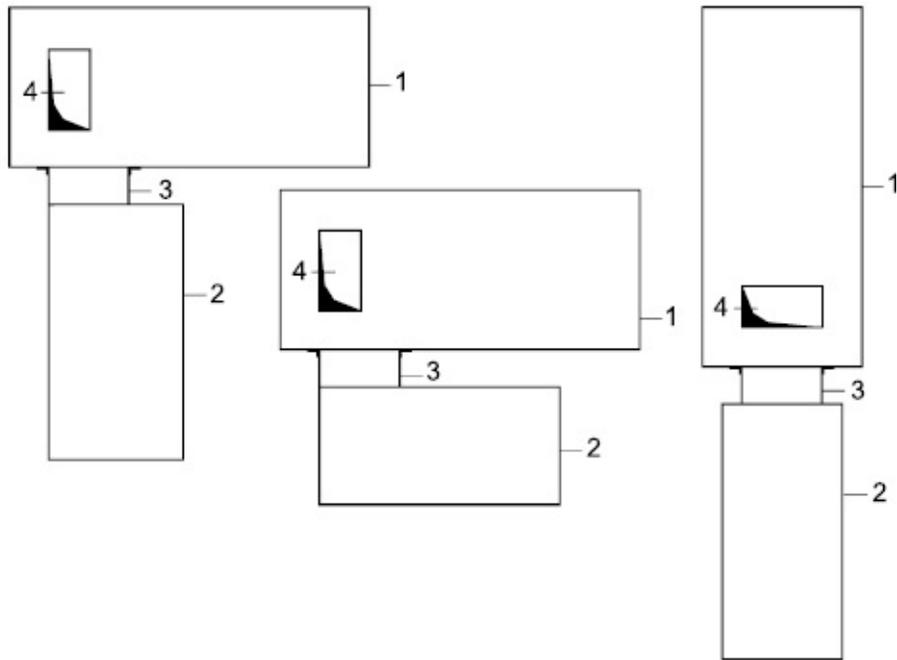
Способы подключения стального топливника к отопительному щитку: 1 – отопительный щиток; 2 – стальной топливник; 3 – соединительный патрубок; 4 – дымовой канал отопительного щитка
